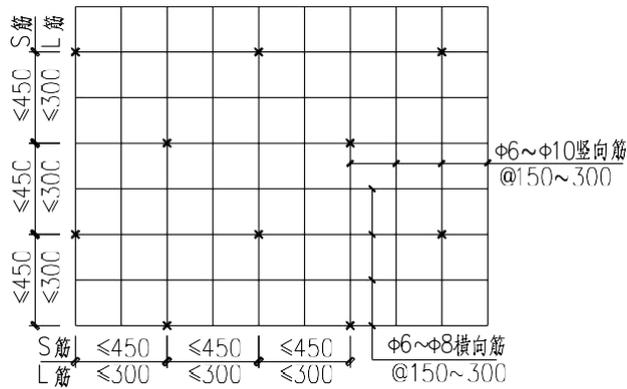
钢筋网片及拉结筋设置示意图
